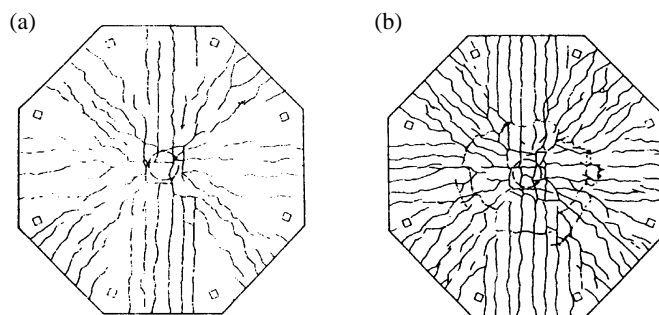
Estágios de fissuração na face superior de uma laje simétrica.
